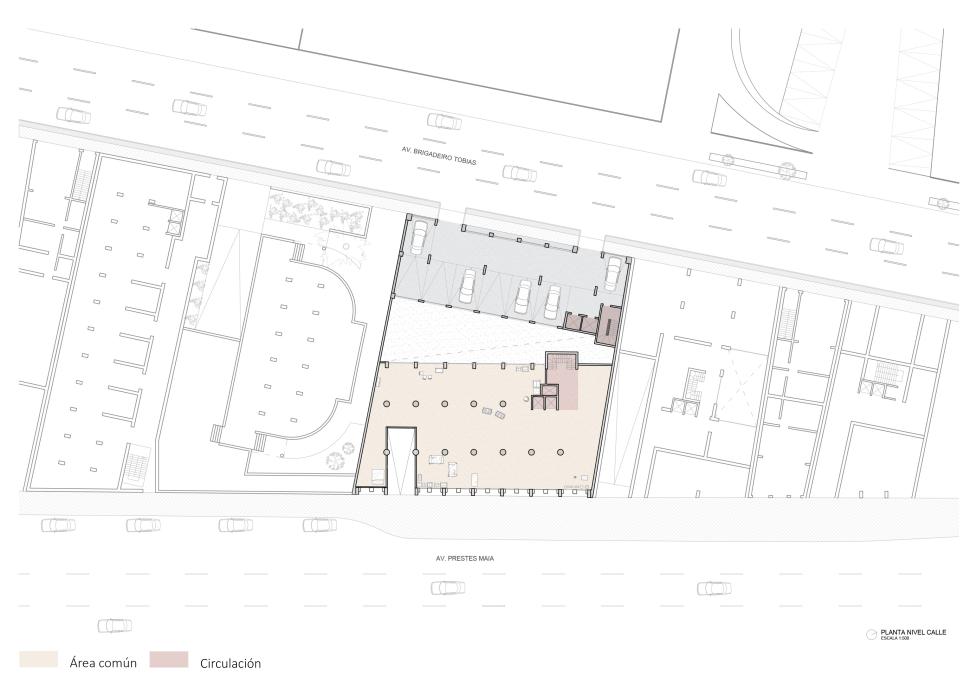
Planta Nivel Calle Fuente: Elaboración propia
